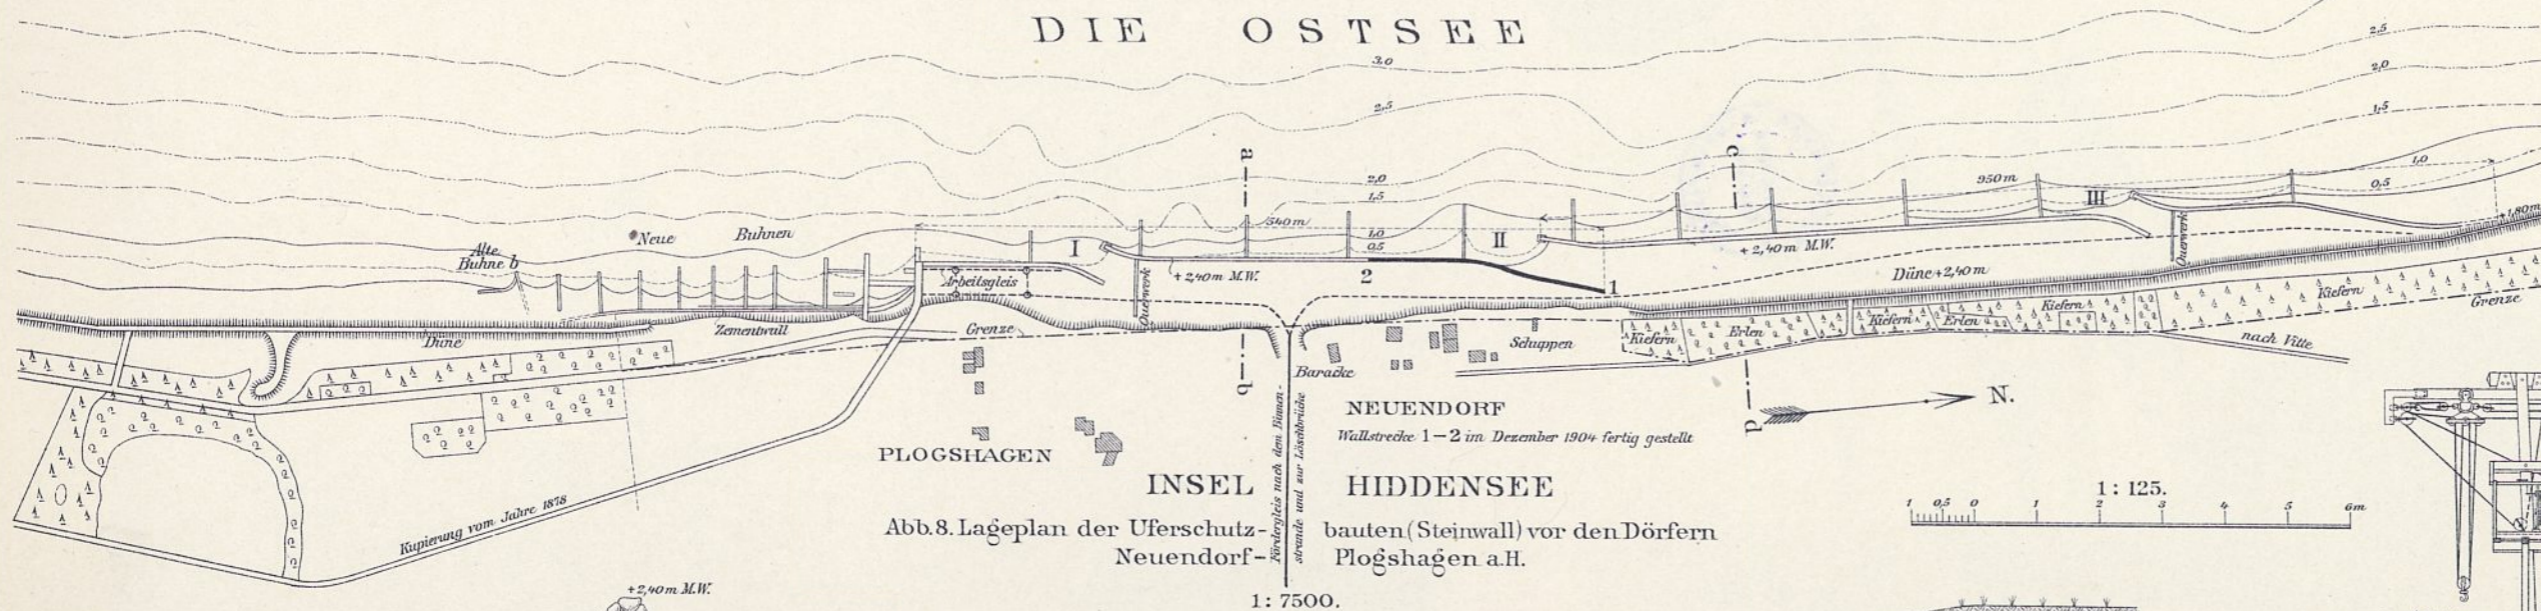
Lageplan der Uferschutzbauten (Steinwall) vor den Dörfern Neuendorf, Plogshagen a.H.
